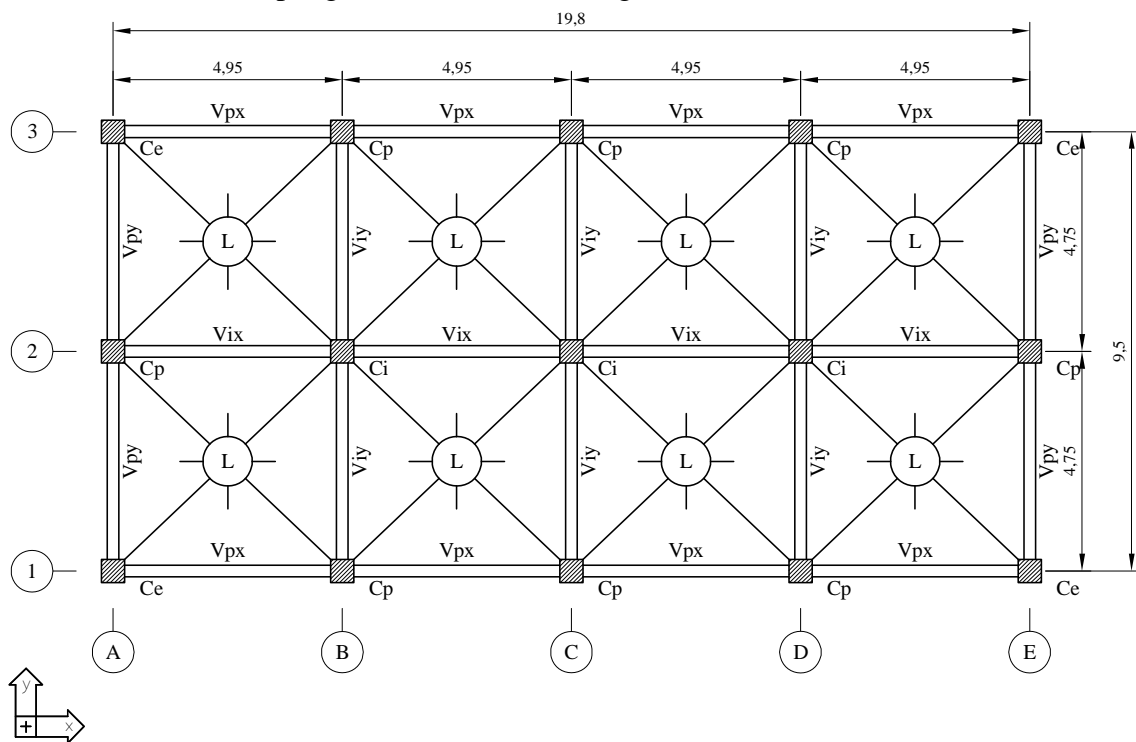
Vista en planta de las estructuras de tres y diez niveles.
